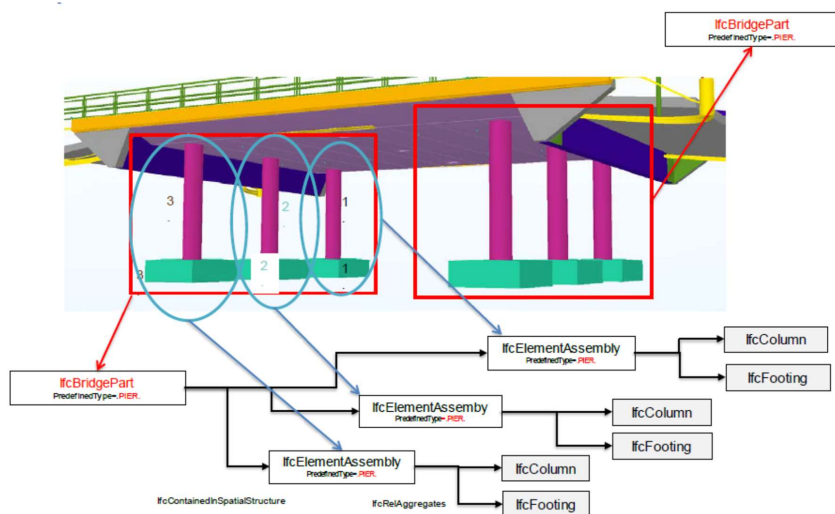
IfcBridge におけるクラス間の階層構造（出典：IFC Bridge Fast Track Project Report WP2: Conceptual Model）
